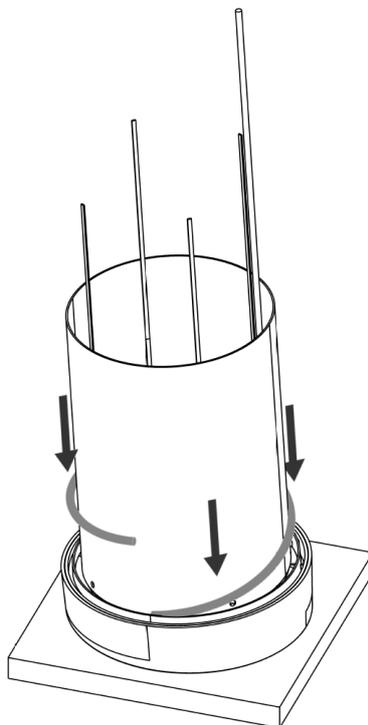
Bande d'étanchéité sur le chapeau de ventilation
